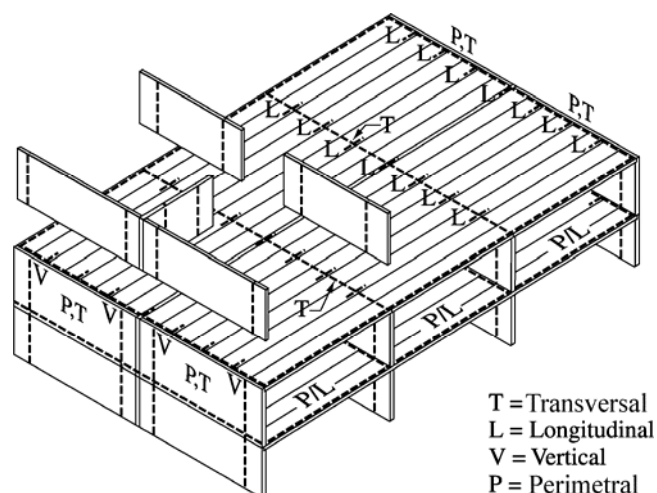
Disposición típica de amarres de tracción en estructuras de grandes paneles
